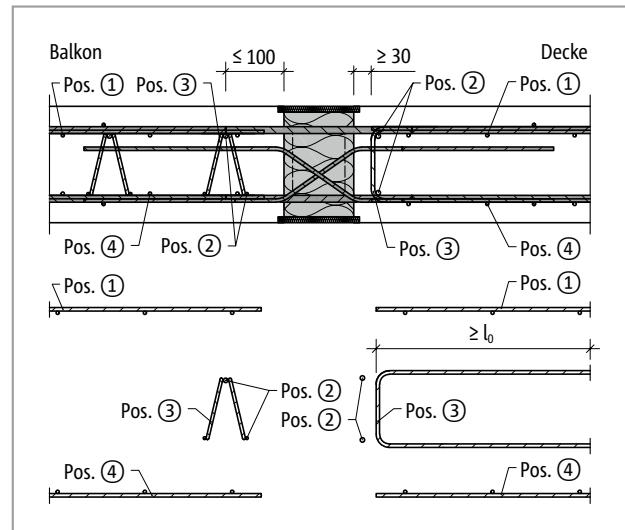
Schöck Isokorb® XT Typ D: Bauseitige Bewehrung mit Gitterträger
